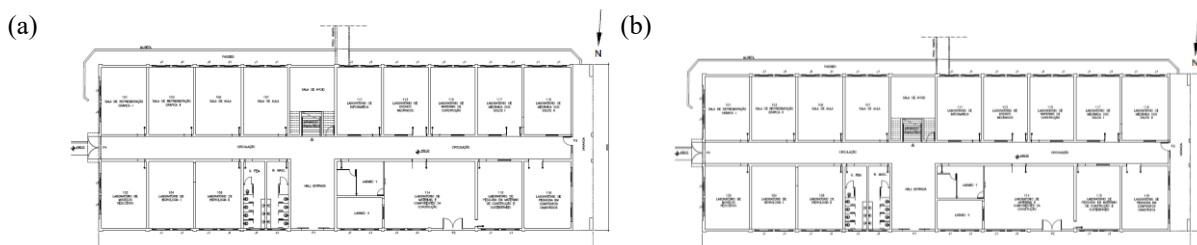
Plantas baixas do (a) 1º pavimento e (b) 2º pavimento do Prédio 12. Fonte: Adaptado de Divisão de Projetos do CEFET-MG.
